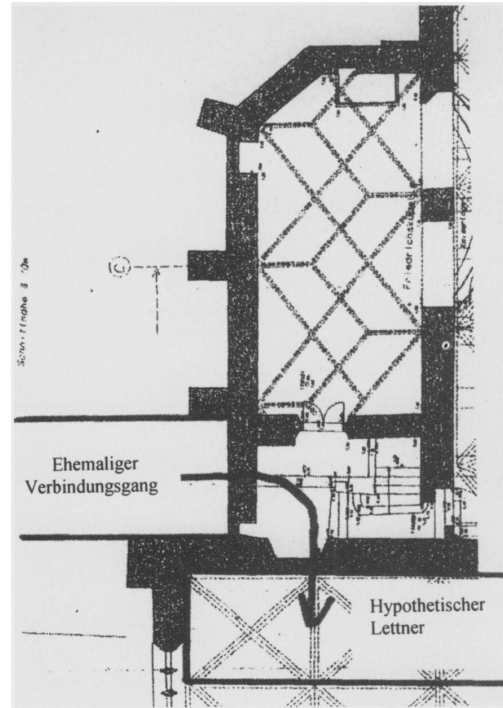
Grundriss der Friedrichskapelle und des Verbindungsgangs mit Lettner, mit Einzeichnung durch Gudrun Ponn-Lettner.
